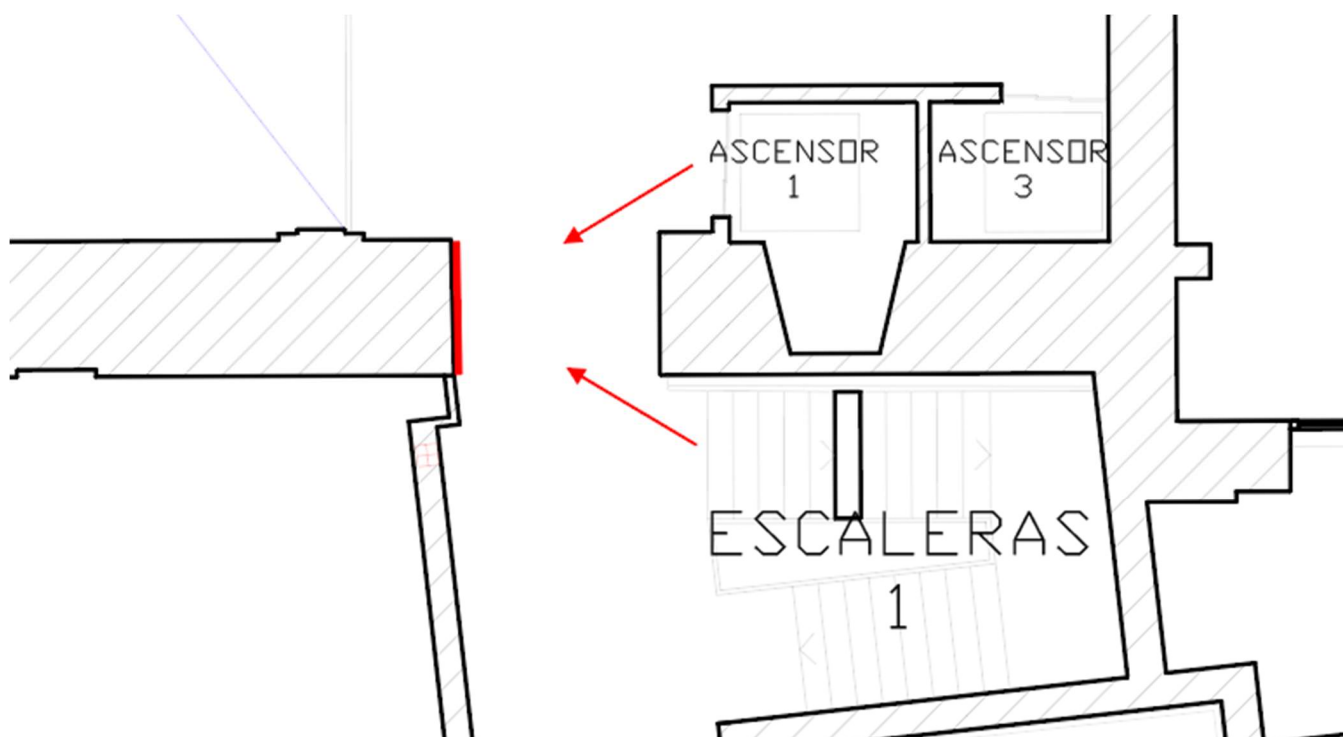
Propuestas de ubicación de directorio Planta 0
